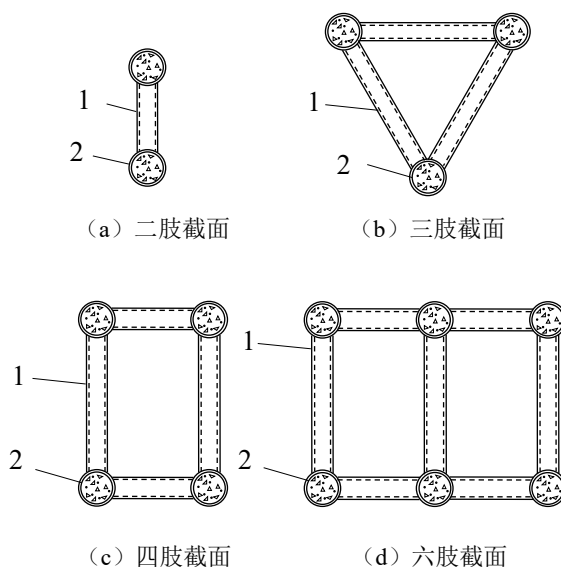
桁式钢管混凝土构件截面示意图
